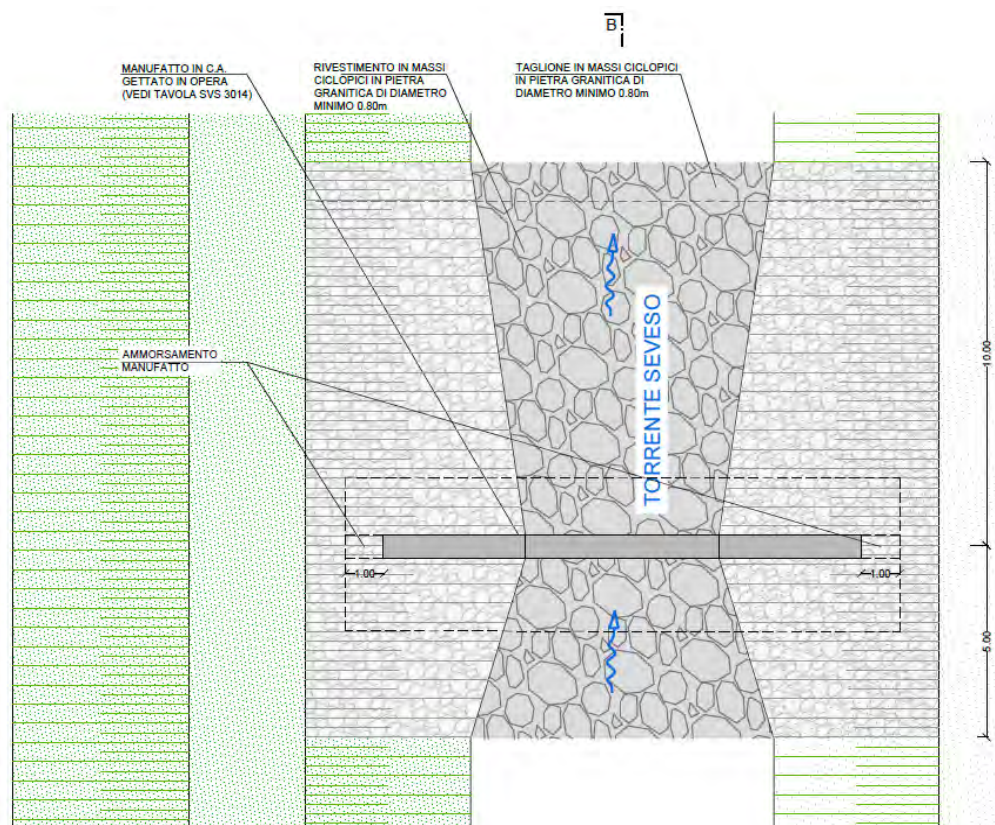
Pianta tipo del manufatto di restringimento delle aree golenali
